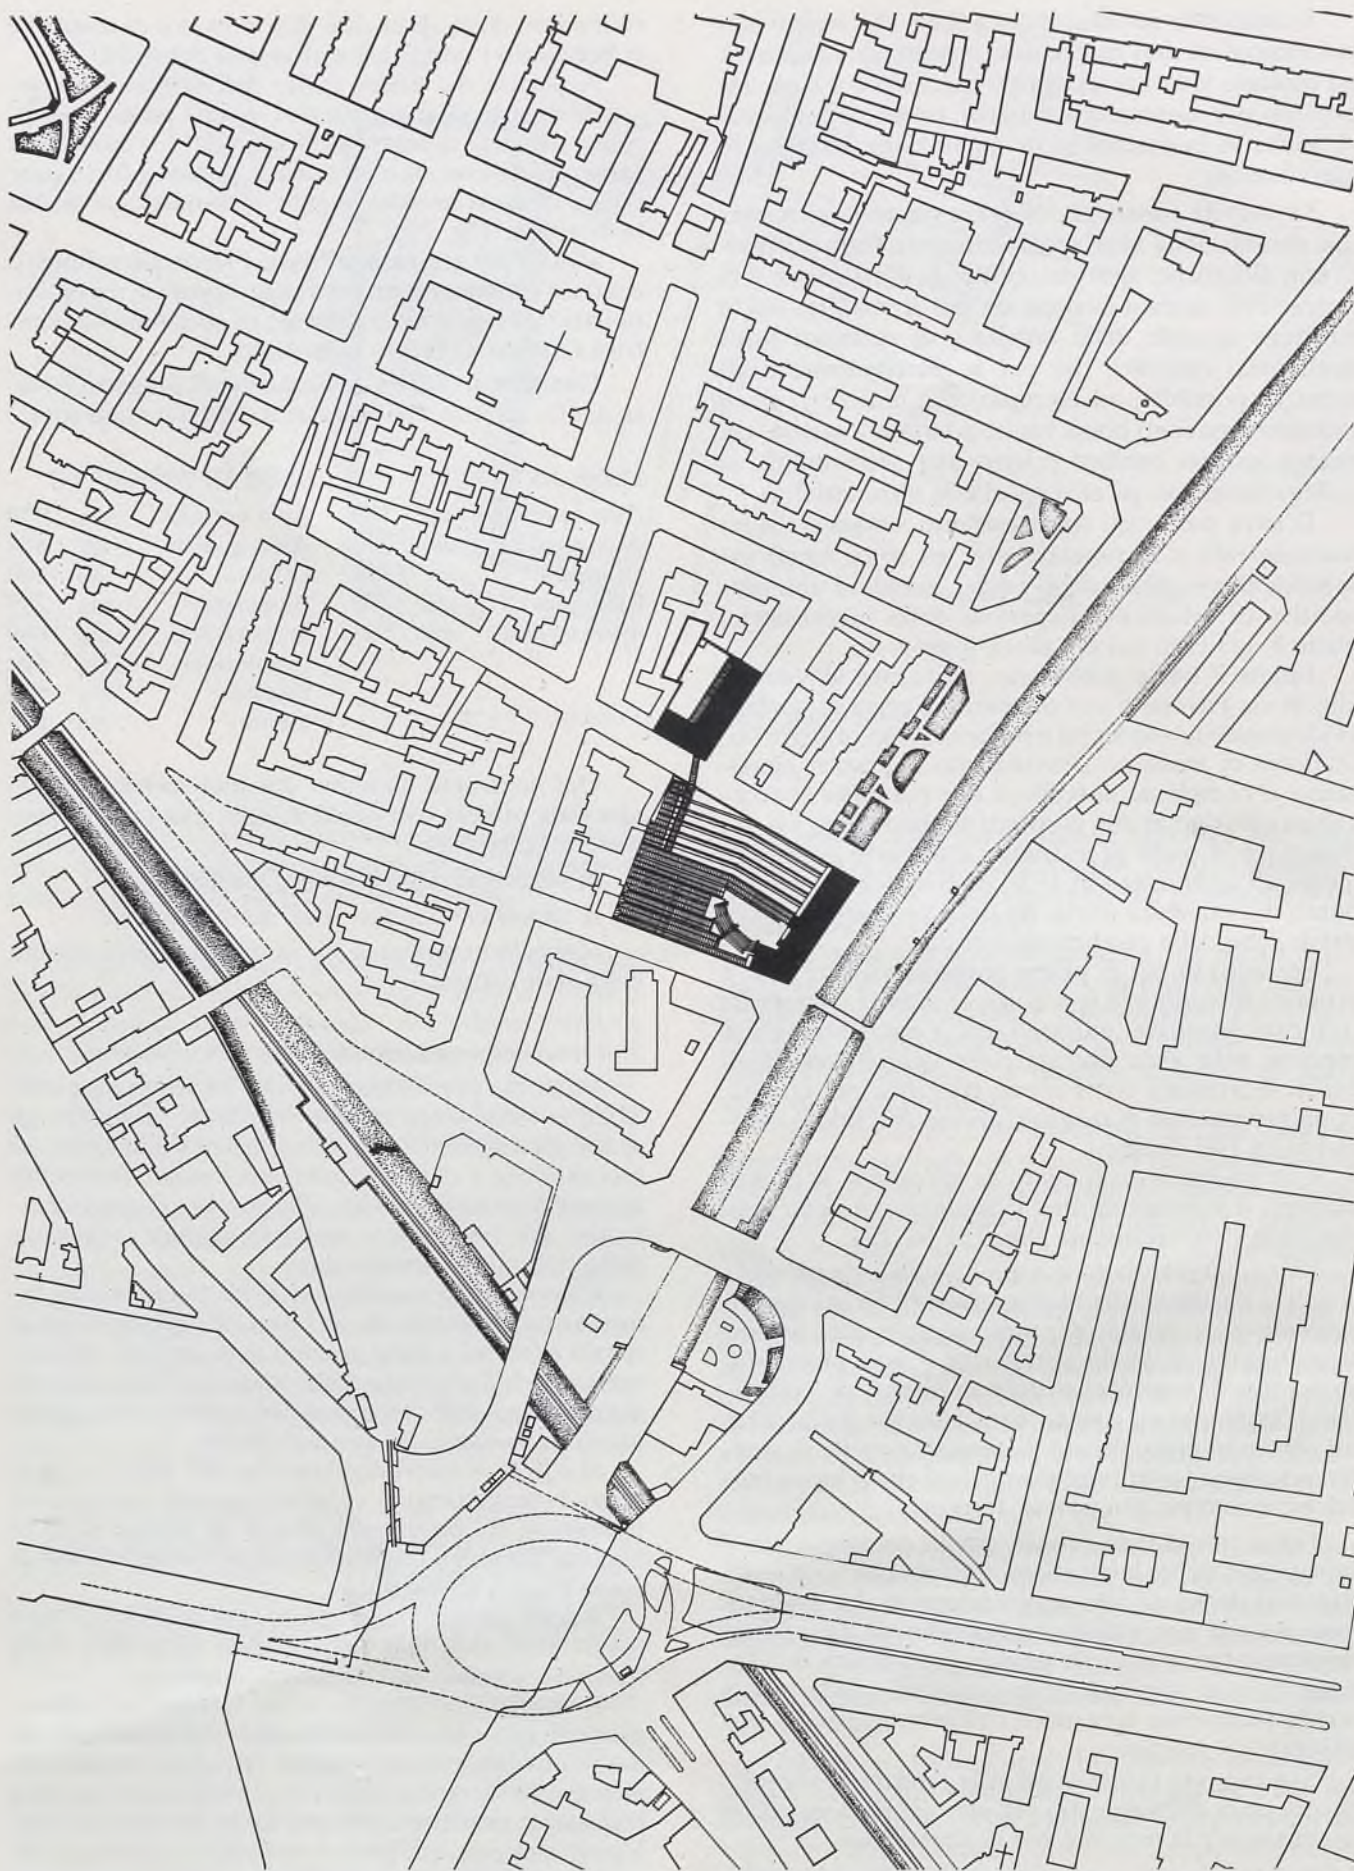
Il progetto nel contesto urbano. Planimetria 1:2000.
